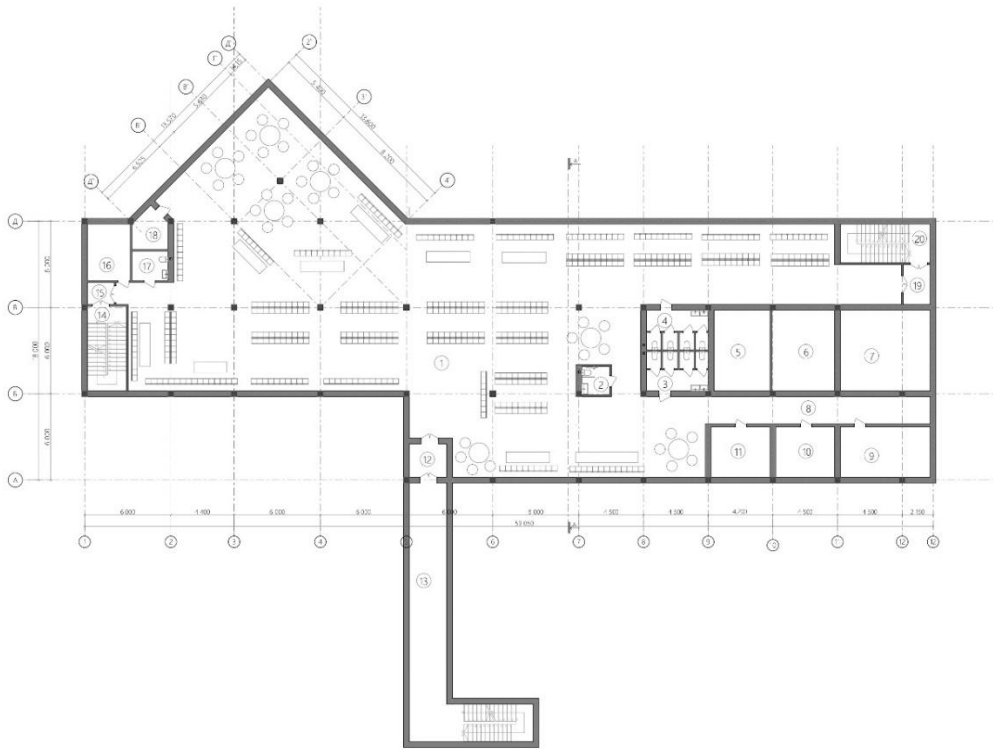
План -1-го поверху на відмітці - 3.800 М1:100
